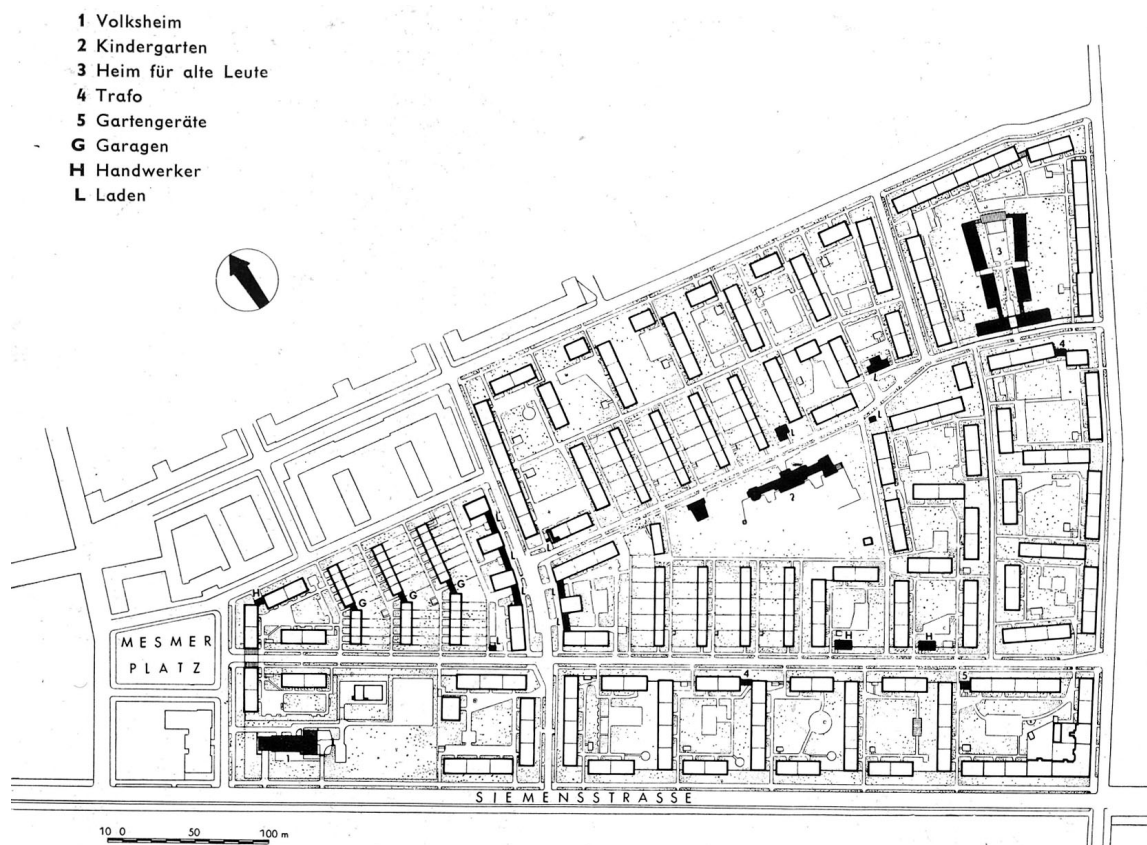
Lageplan der Wohnhaussiedlung an der Siemensstraße [5]
